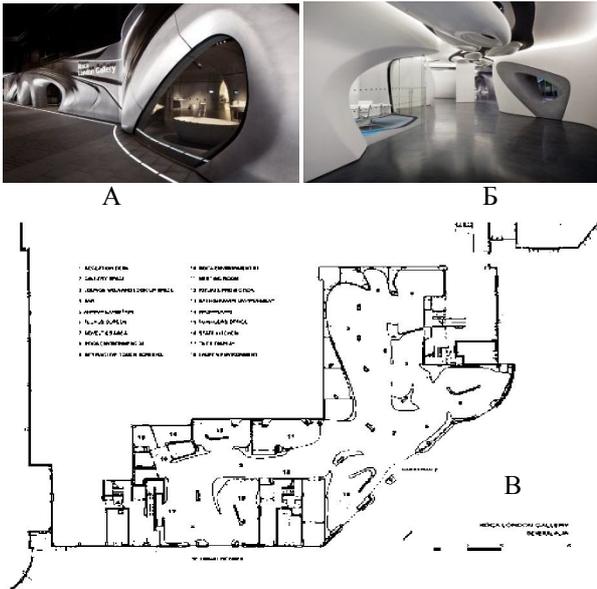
Галерея Roca London от студии Zaha Hadid Architects А-фрагмент главного фасада, Б- фрагмент интерьера, В- план здания
